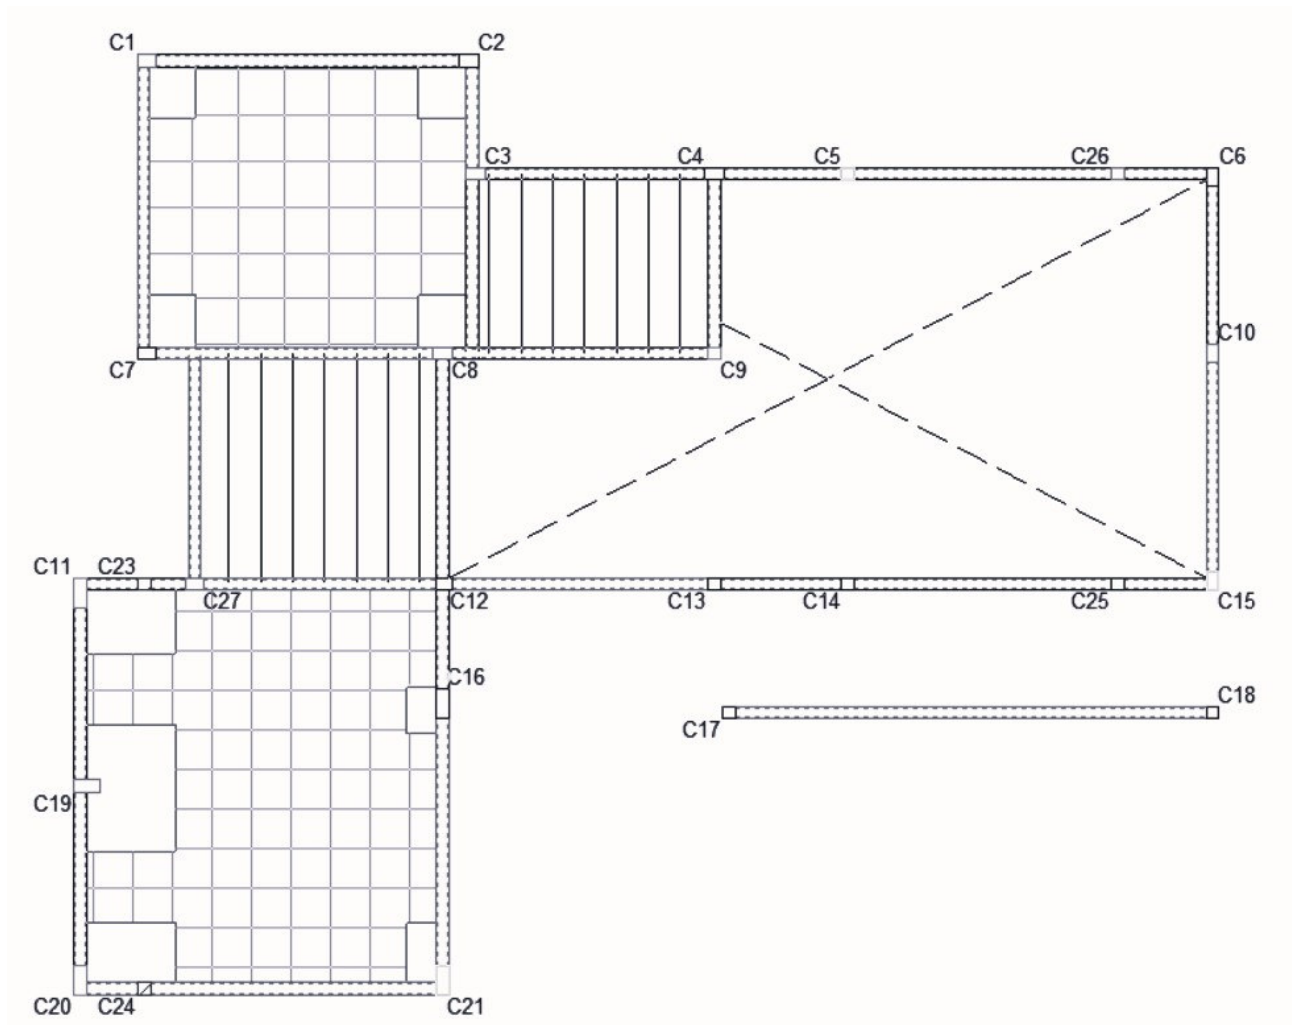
Ubicación en planta de ábacos en losas casetonadas
